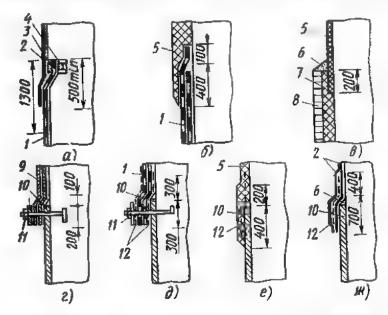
Сопряжения гидроизоляции на вертикальных поверхностях (а-аг):
